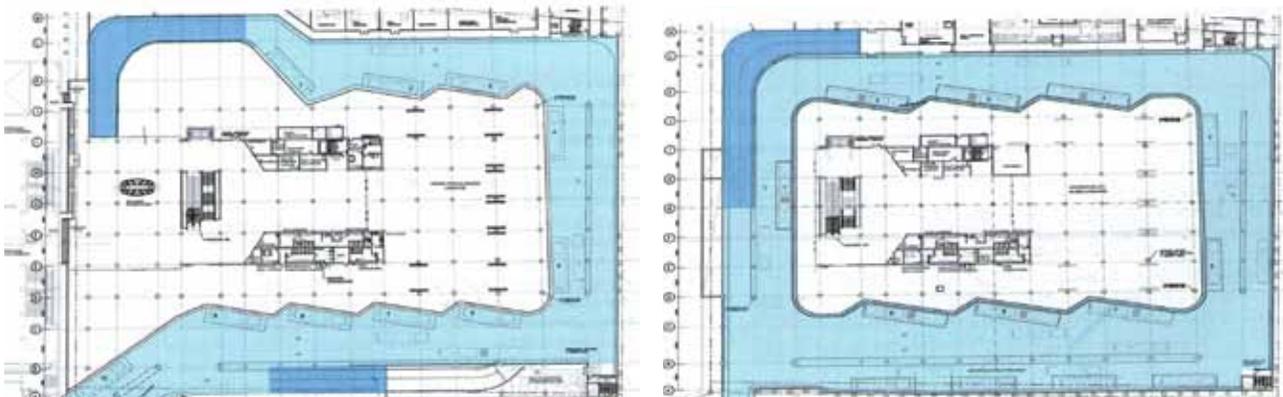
Planimetría estación La Cisterna y su esquema de funcionamiento.
